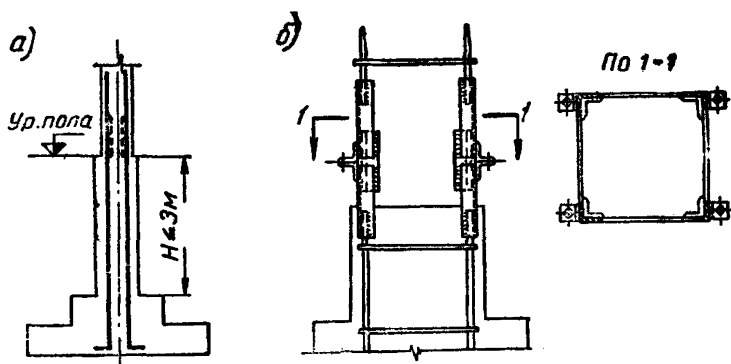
Стыки рабочей арматуры колонн со стержнями, выпущенными из фундамента
